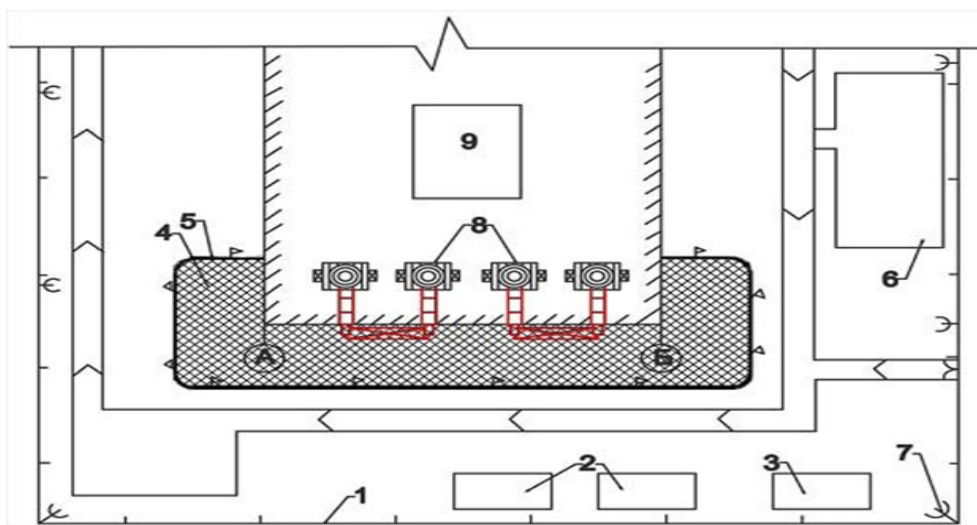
Схема организации строительной площадки при устройстве рационального решения НВФ с минимумом затрат в многоквартирном доме: 1 – ограждение строительной площадки; 2 – мастерская и санитарно-бытовое помещение для рабочих; 3 – материально-технический склад; 4 – рабочая зона; 5 – граница зоны, опасной для нахождения людей при эксплуатации фасадных подъемников; 6 – открытая площадка складирования плит минваты, пленка элементов каркаса, облицовочных панелей; 7 – мачта освещения; 8 – 2 фасадных подъемника; 9 – жилой дом с НВФ
